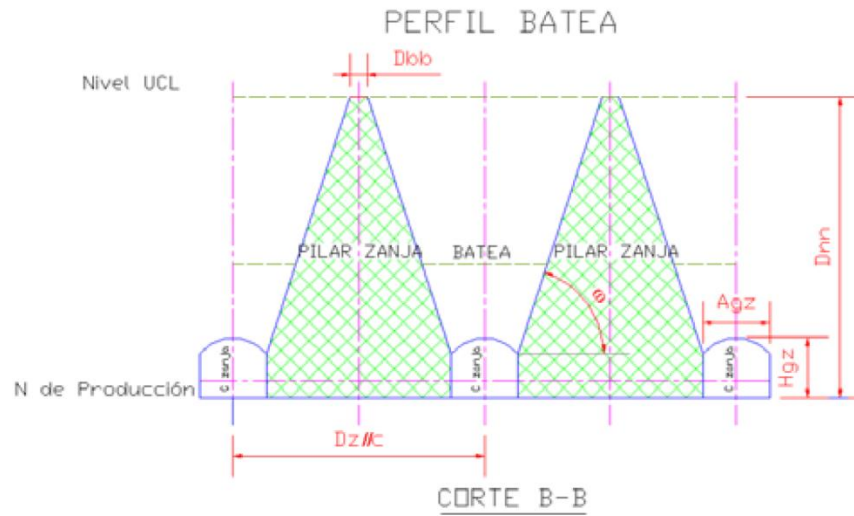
Diseño de Batea y Pilar Zanja en perfil perpendicular a galería de Zanja. (Cavieres et al., 2002)
